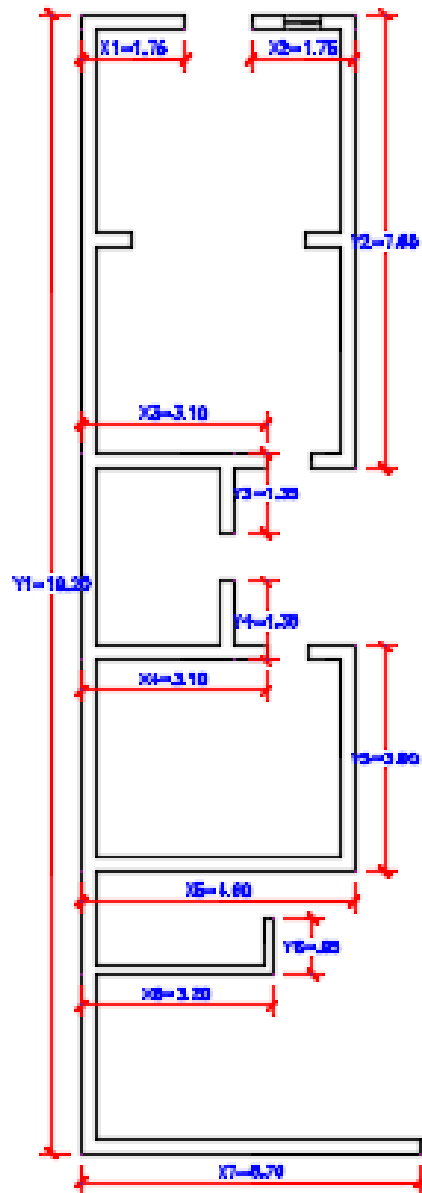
Muros portantes de Vivienda 22, vista de planta.
